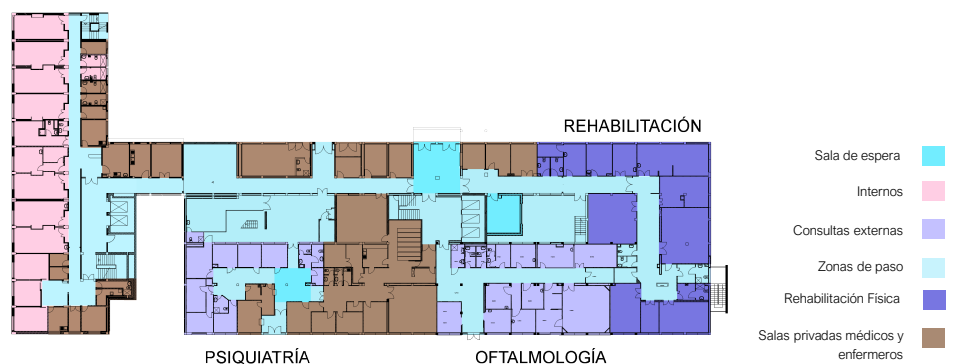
Planta baja bloques 6/8. Análisis de distribución de áreas. Plano base oficial facilitado por el Ingeniero Paulo Costa. Análisis gráfico realizado por Laura Castro.
